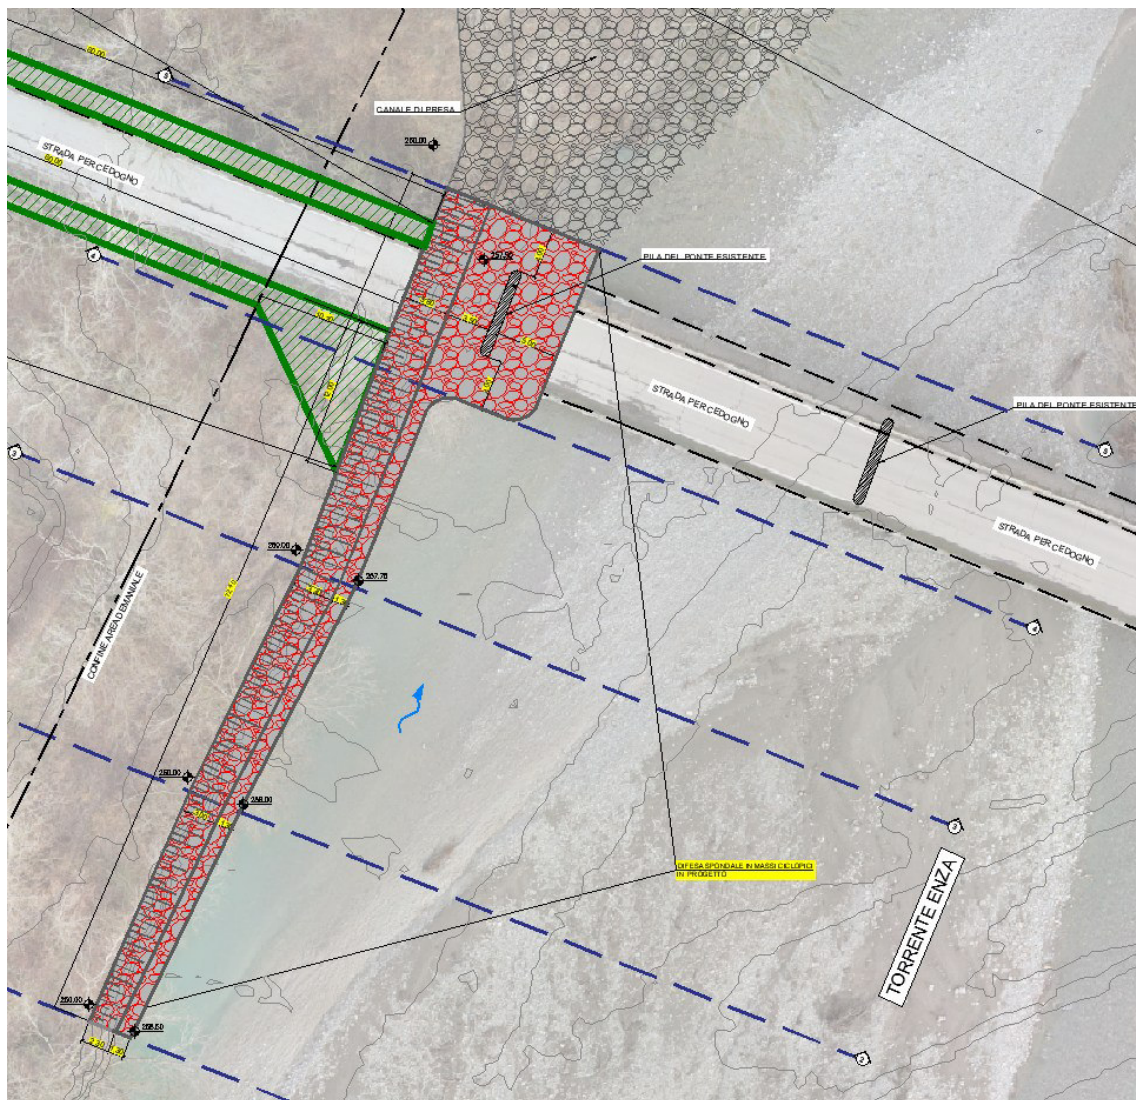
Stralcio planimetrico delle difese spondali da realizzare a monte della briglia
